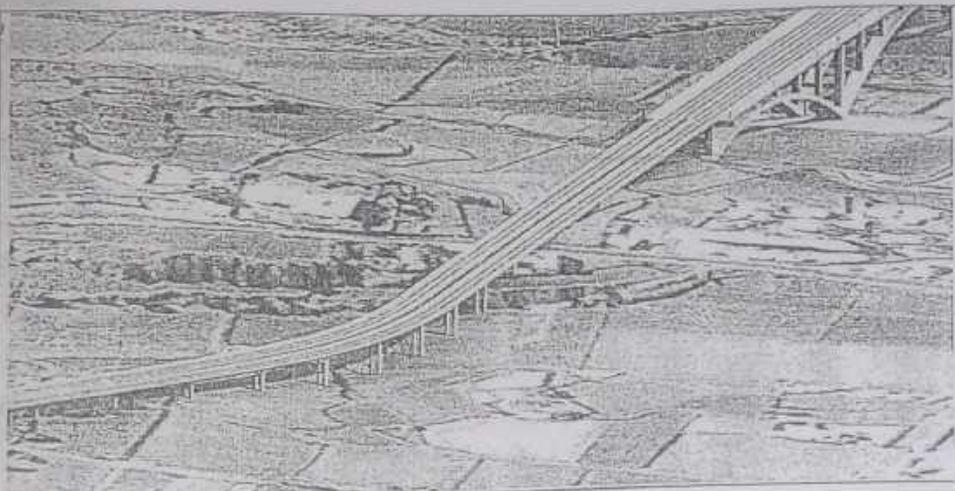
Vista Panorámica del futuro viaducto del tramo 4 correspondiente entre la vía a Carmen Alto y la Avda. Cayma. El viaducto tiene altura promedio aproximada de 8 Metros y permite que se intervenga lo menos posible la andenería del Valle de Chilina, no interrumpe la operatividad de las labores agrícolas, infraestructura de riego, circulación, etc. Por otro lado el viaducto servirá como un mirador para apreciar la campiña.
